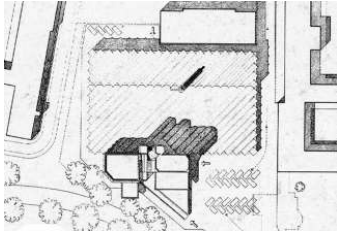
Planta de conjunto de la Escuela de Ingeniería de Leicest. Inglaterra, 1959-1963. James Stirling.
